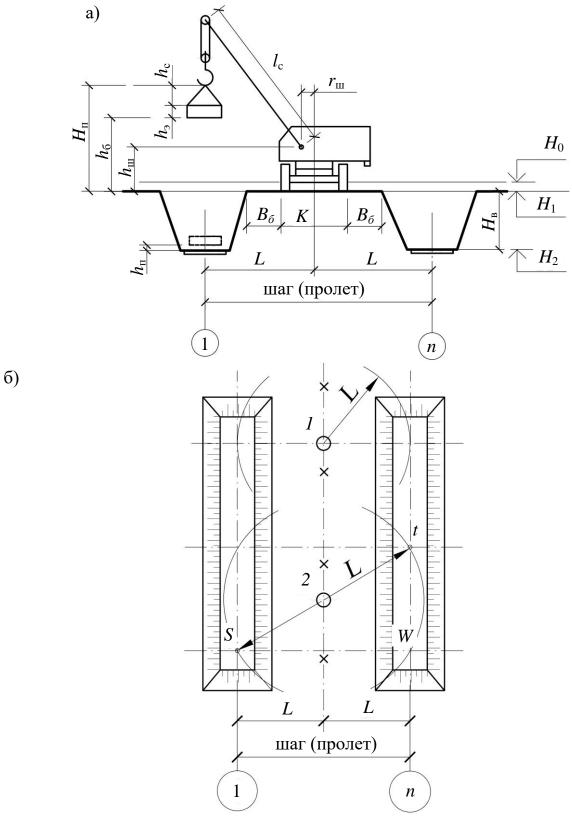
Схема установки крана для монтажа двух или четырех фундаментов с одной стоянки: а) монтаж фундаментов в двух выемках с одной стоянки; б) план установки крана для монтажа двух или четырех фундаментов с одной стоянки
